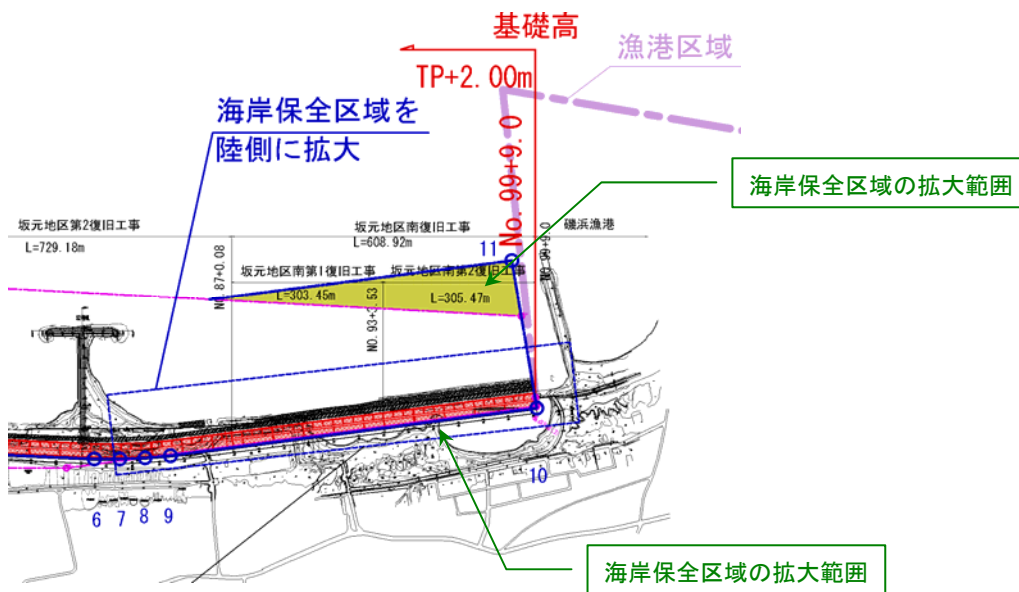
海岸保全区域の拡大区間平面図 (No.83～No.99)
